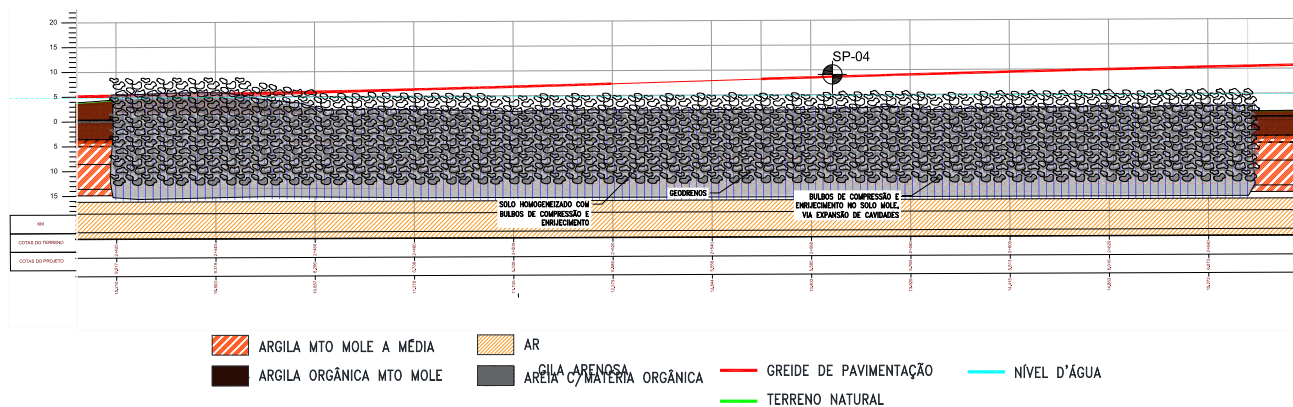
Perfil geológico geotécnico do Segmento P|01 com Geoenrijecimento.
